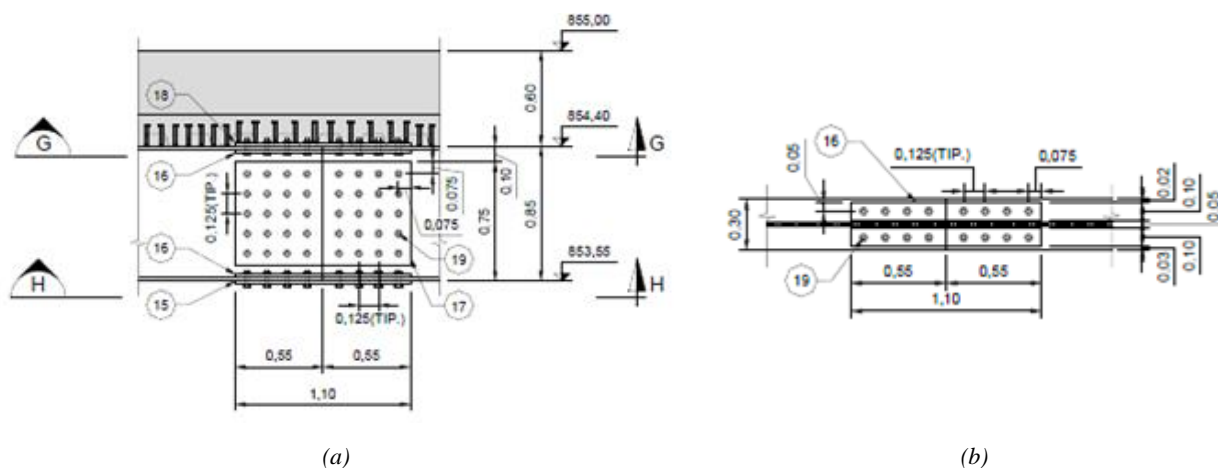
Empalme vigas principales- Puente entre unidades - (a) Vista; (b) Planta
